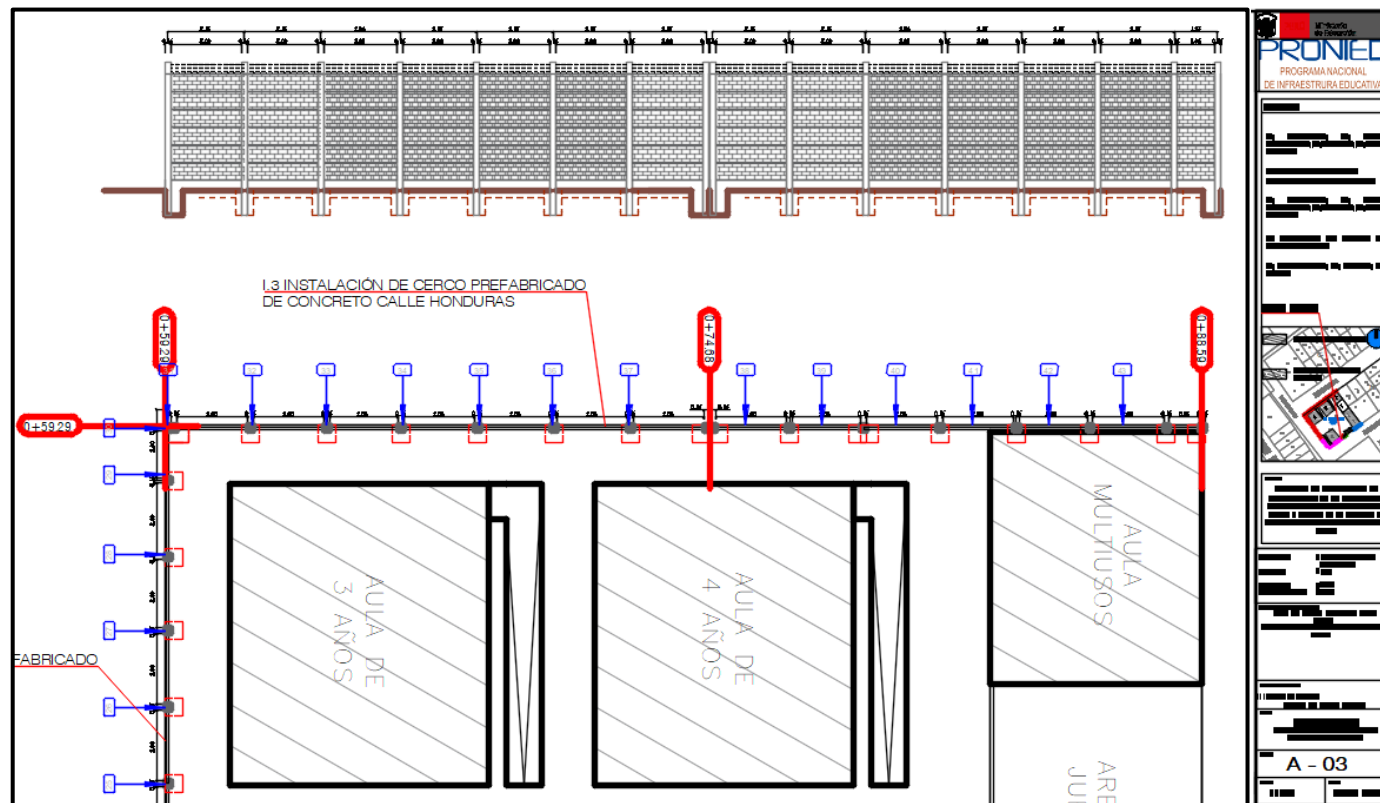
Intervención de cerco perimétrico prefabricado de concreto en lindero posterior hacia Calle Honduras
